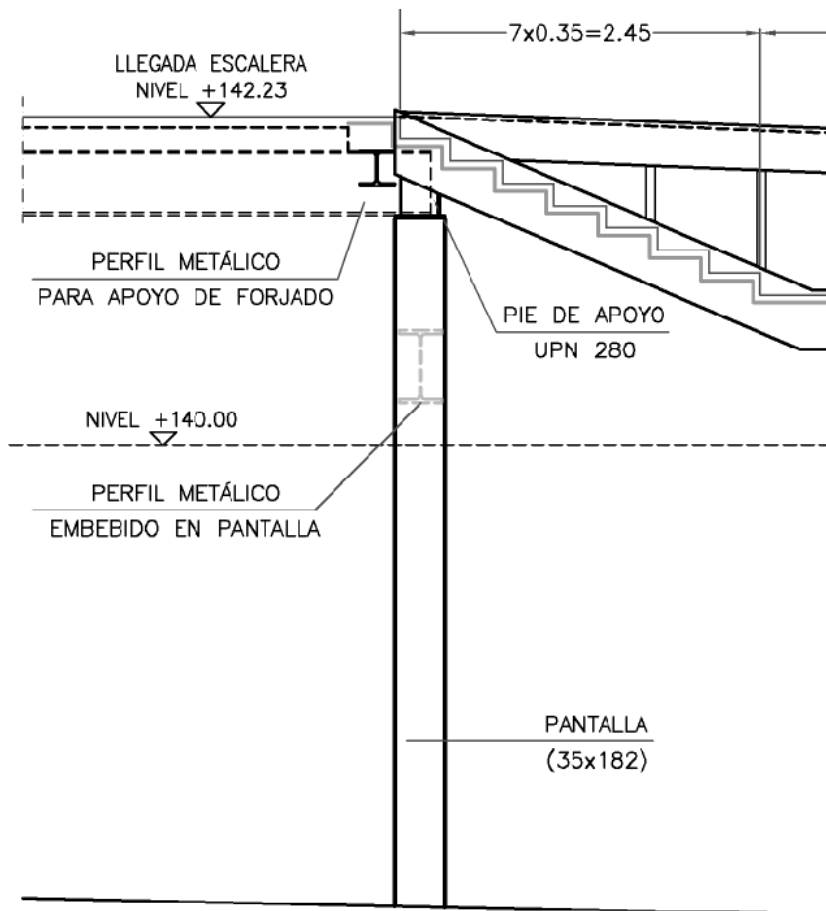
Pantalla de apeo y de apoyo de zancas de escalera y de vigas de cubierta
